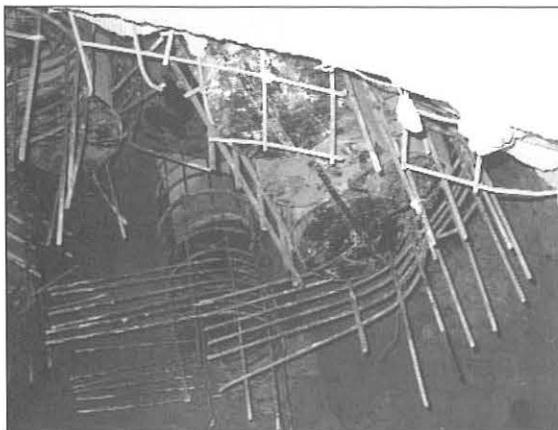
Holzpfähle der Gebäudefundierung mit entsprechender Umfassungsbewehrung (Blick in die Firste des Tunnels)
